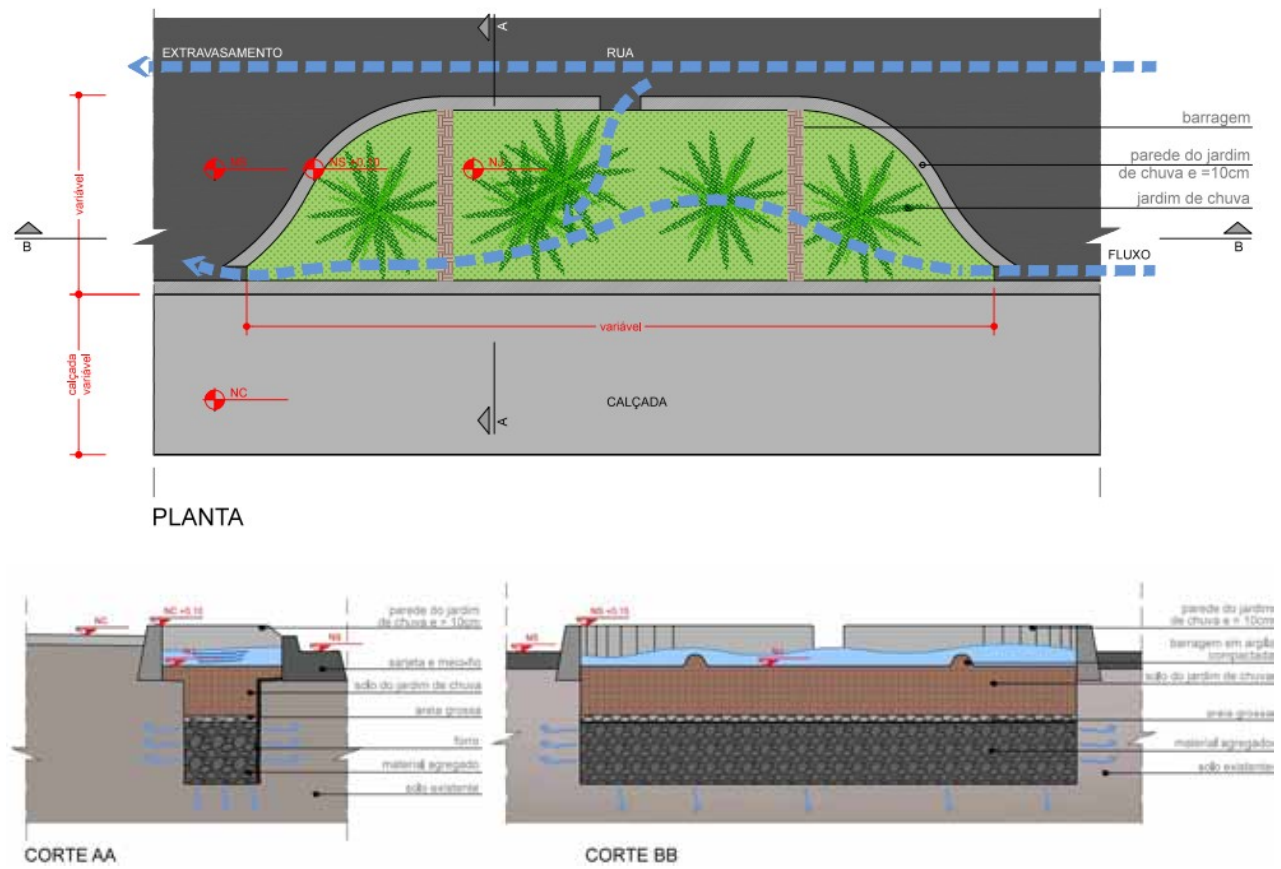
Jardim de Chuva na Calçada – Projeto Implantado
